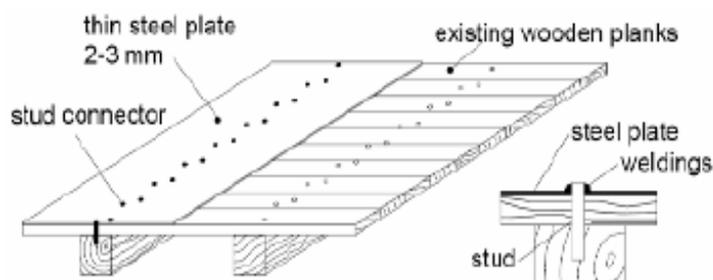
Reforço de pavimento através da aplicação de chapas metálicas finas (Marini, 2006)
